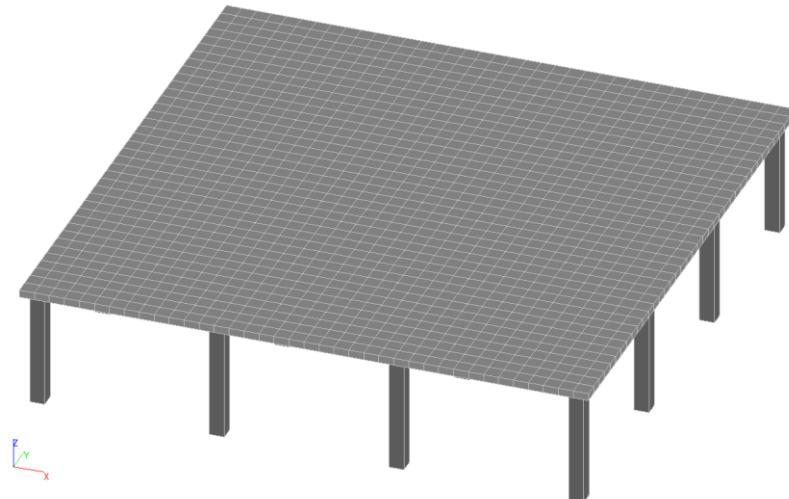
Расчетная схема облегченной плиты перекрытия
